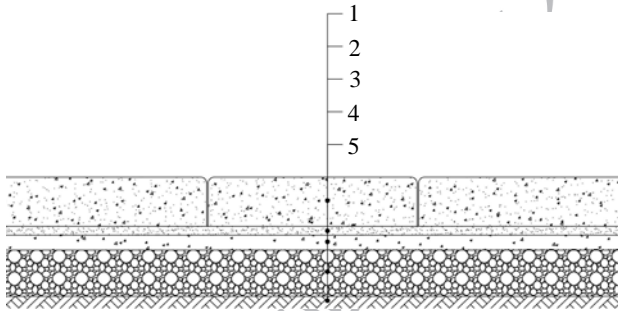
多孔隙透水混凝土板路面结构层示意图
